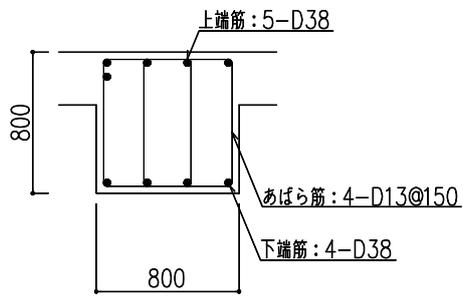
大ばりの配筋図 (2階, X8a 通り YM~YN 通り間, 端部) (単位: mm)
